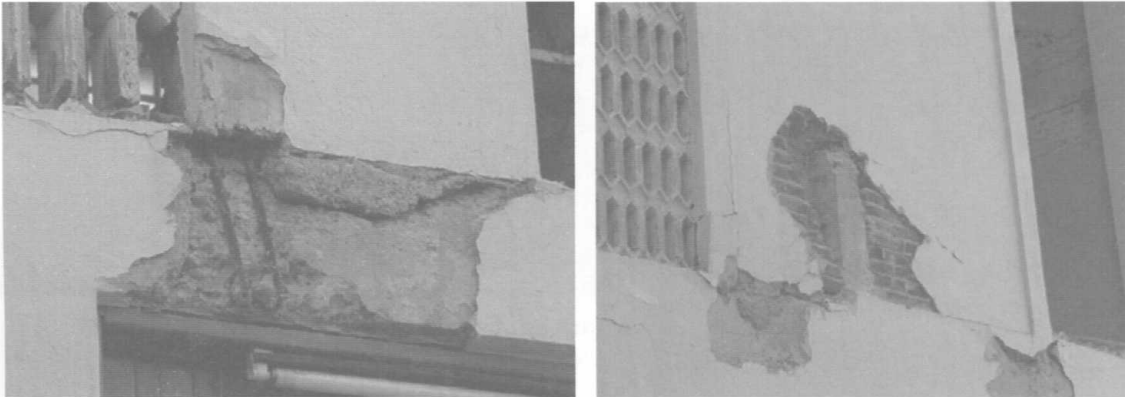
Articulaciones plásticas en las vigas y daño en las conexiones deficientes de los muros de mampostería
